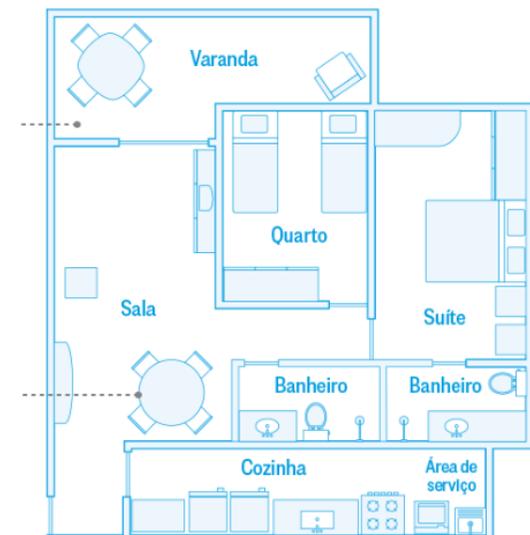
Planta baixa moradia anos 90. (Fonte: Blog da arquitetura)
